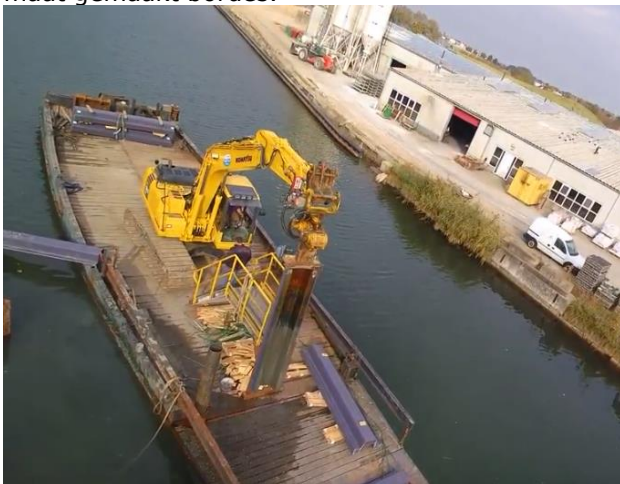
Aansluiting kunststof damwand op stalen damwand (noordzijde)
